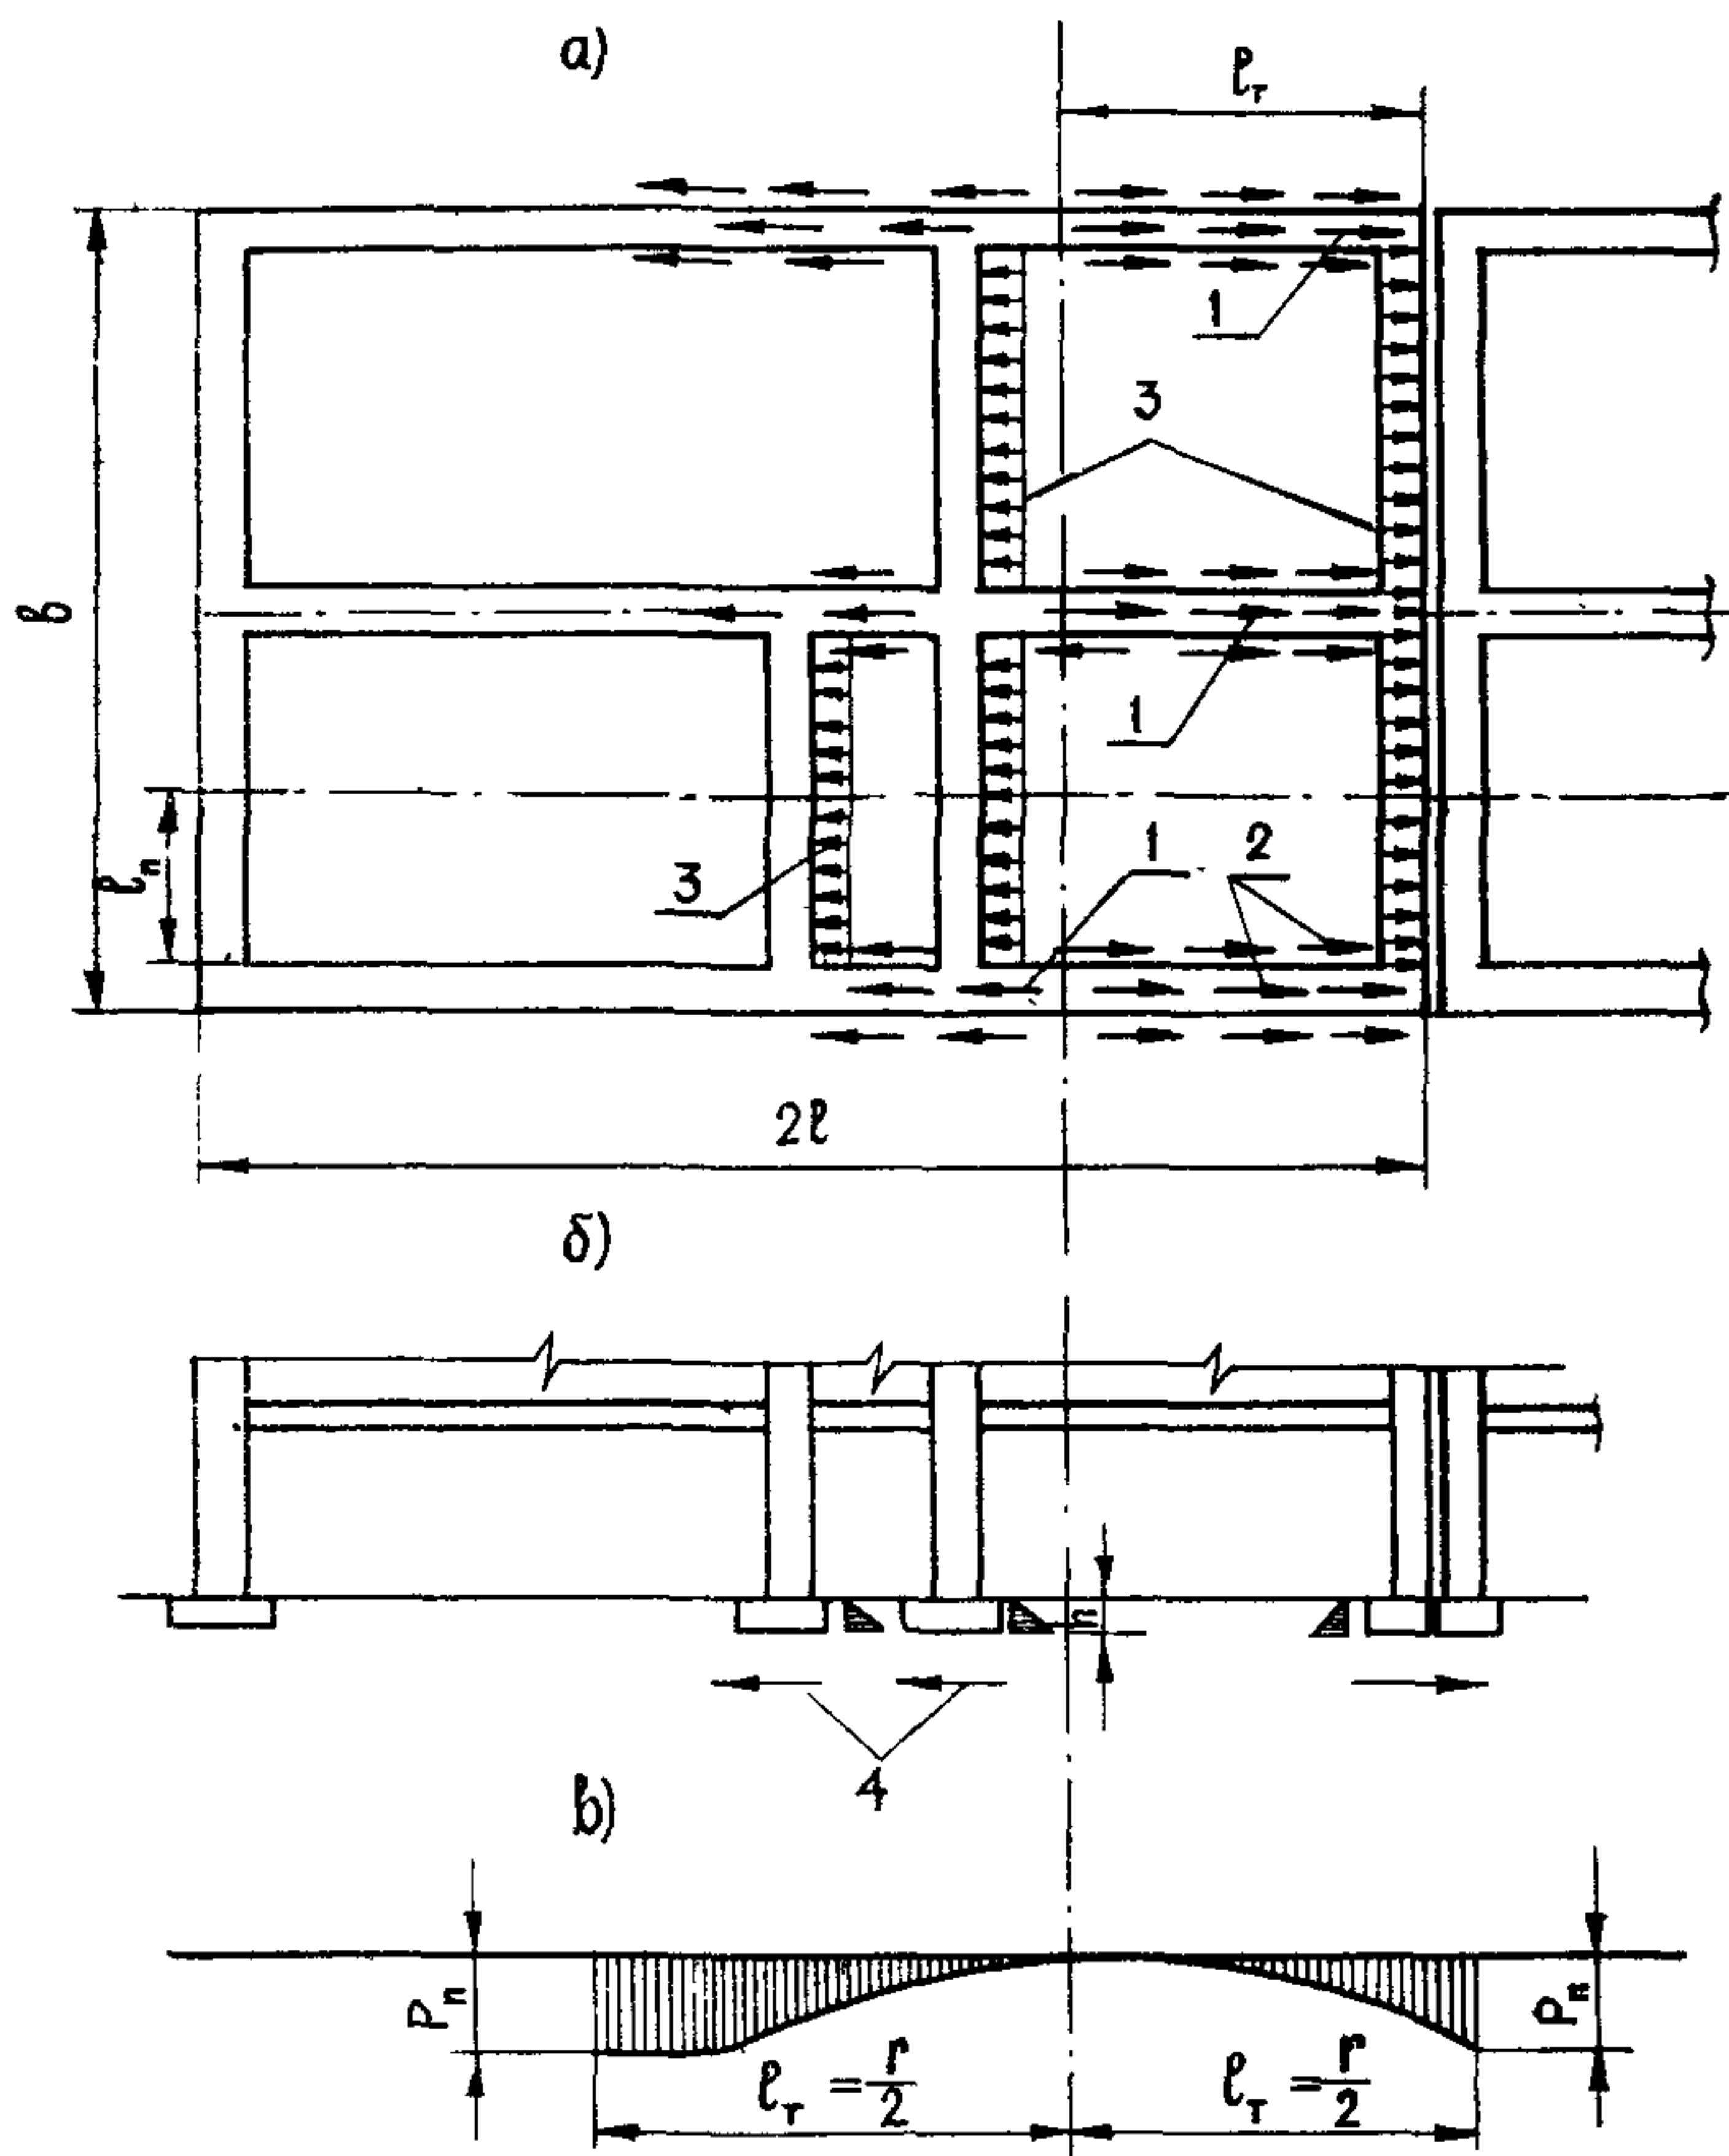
Схема усилий, передающихся на фундаменты под влиянием горизонтальных перемещений грунта при просадке его от собственной массы:
